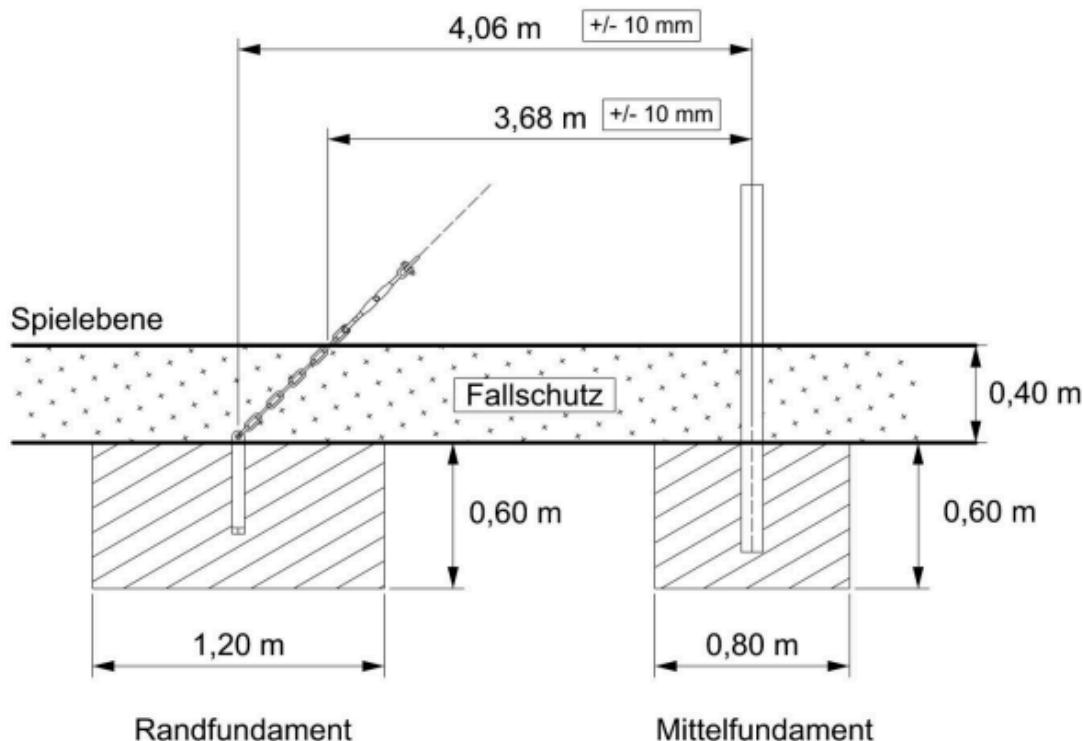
Distanza tra le fondazioni e all'interno dell'area della struttura
